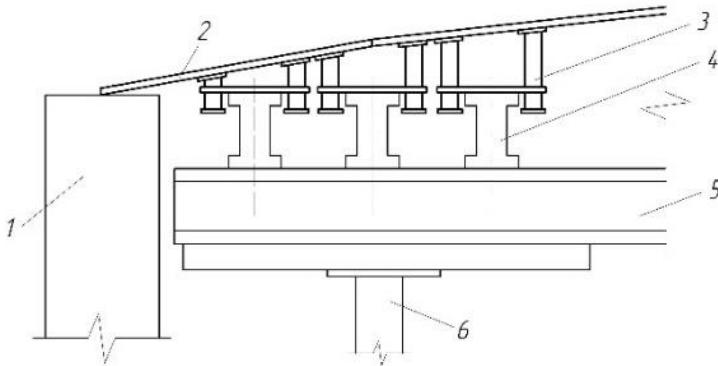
Фрагмент поздовжнього розрізу опалубки:
